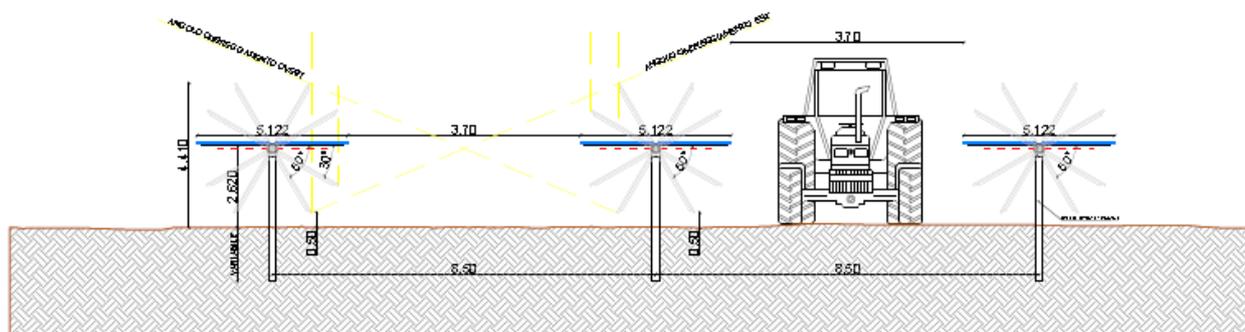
disposizione delle file di lavanda tra le file di moduli fotovoltaici - prospetto
